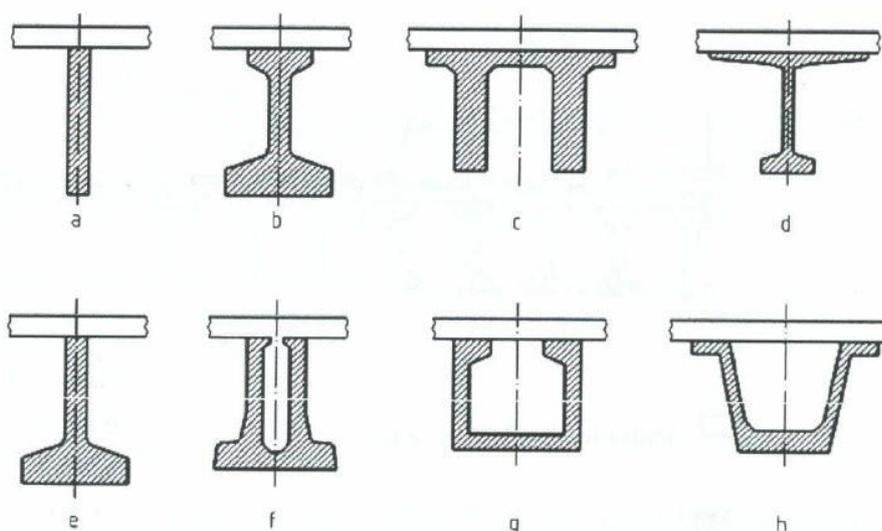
EN 15050:2007 Precast concrete products - Bridge elements
